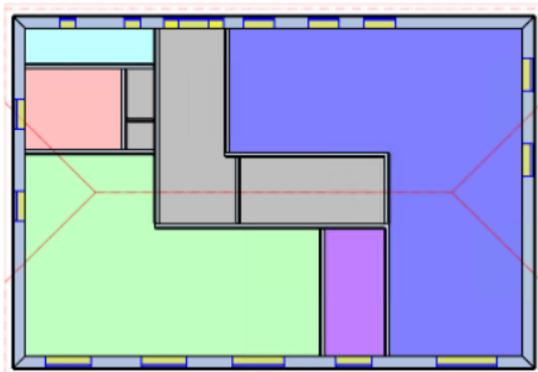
Grundriss Obergeschoss, zoniert
